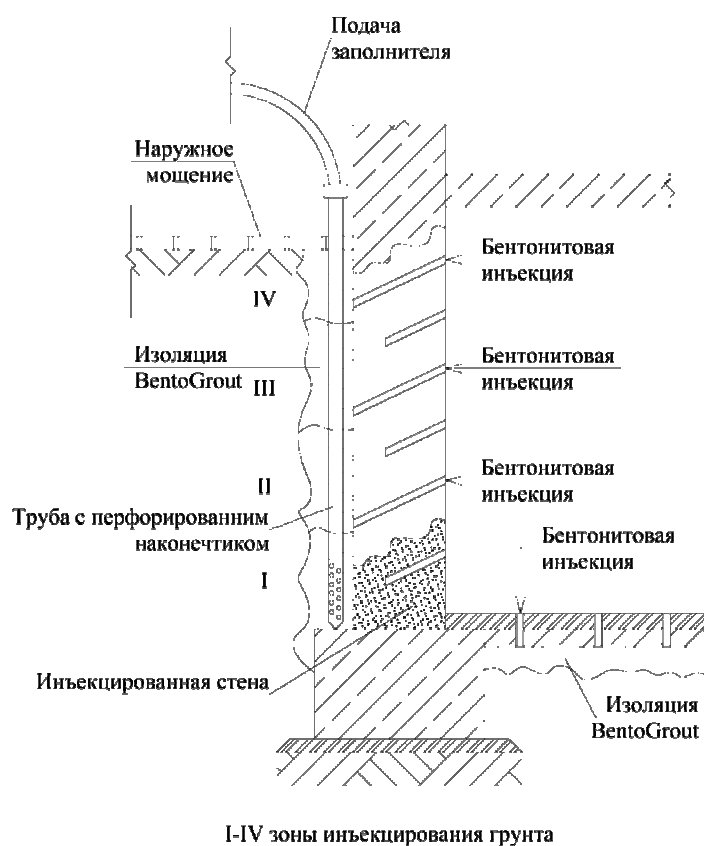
Наружная гидроизоляция фундамента при внешнем интъектировании
